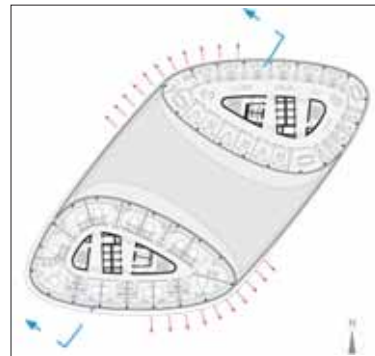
Gebäudeentlüftung // Grundriss
